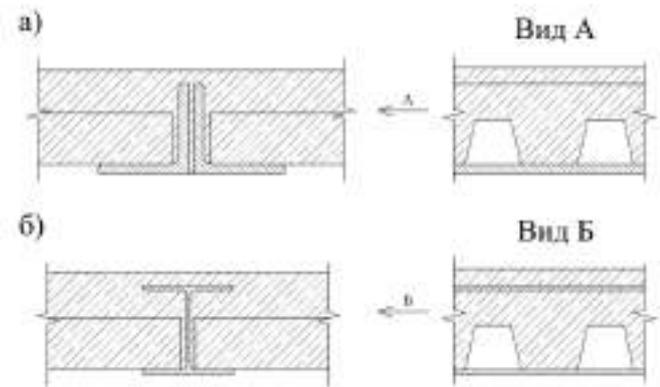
Варианты узлов сопряжения конструкции ферм с монолитным перекрытием: а) верхний и нижний пояс фермы из парных уголков; б) верхний и нижний пояс фермы из двутавра
